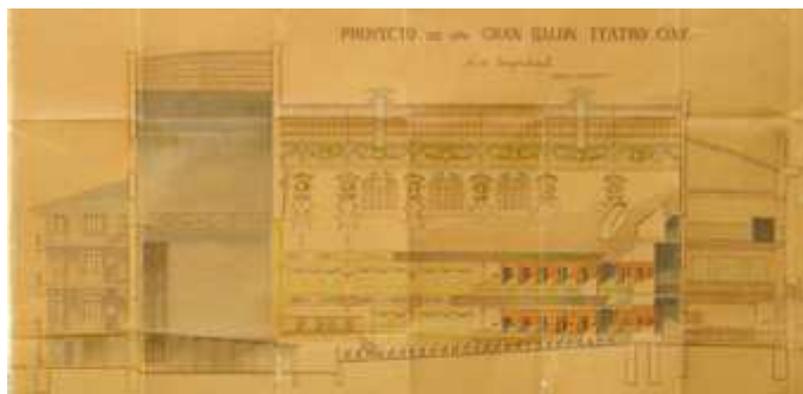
Plano corte longitudinal. (COFFINO, A., *Proyecto de 1913*)
